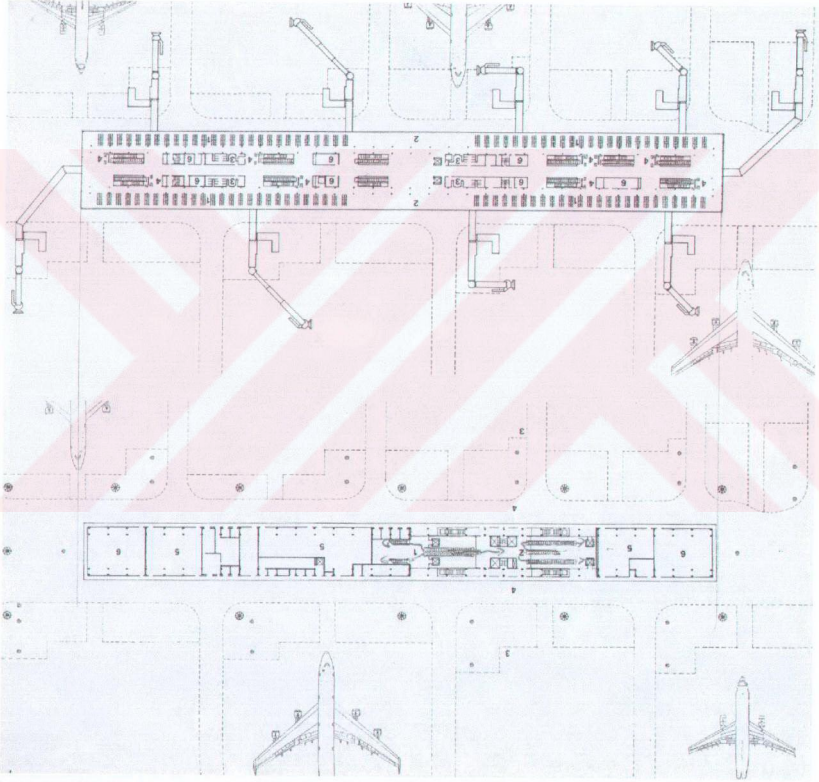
Üstte bodrum kat planı, altta kesit
